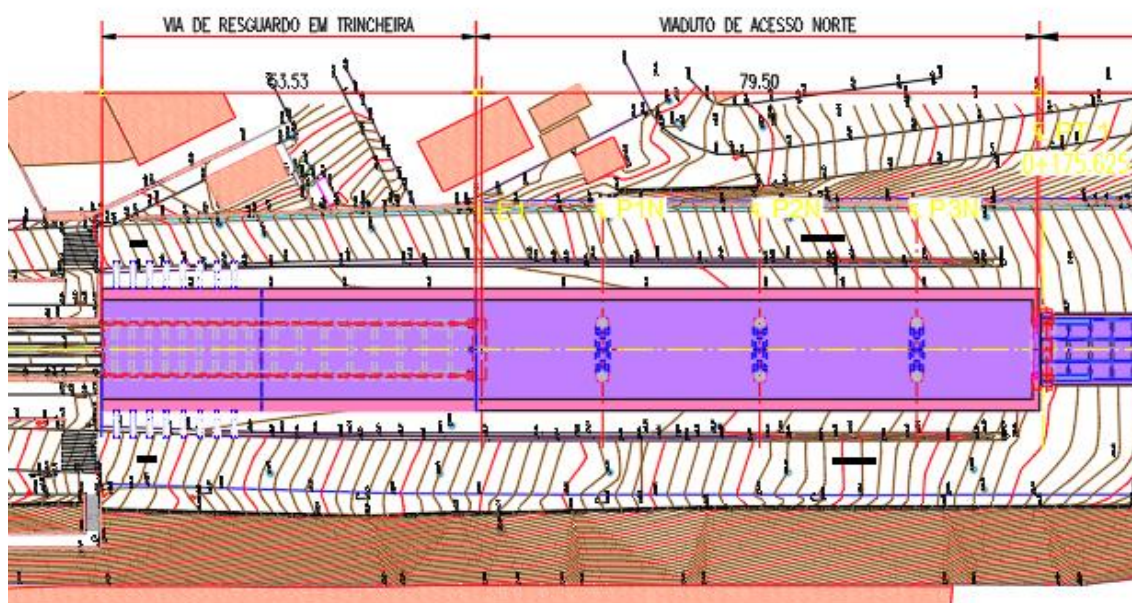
Planta ao nível do tabuleiro Via de Resguardo em Trincheira
